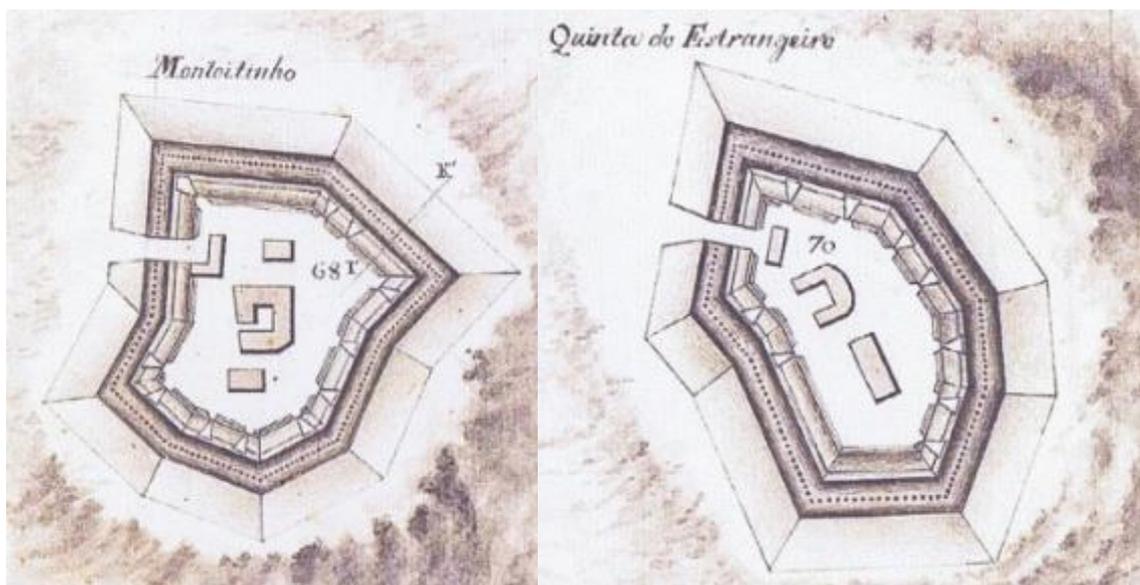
| Forte Matoutinho (reduto nº 68); Forte da Quinta do Estrangeiro (reduto nº 70)
